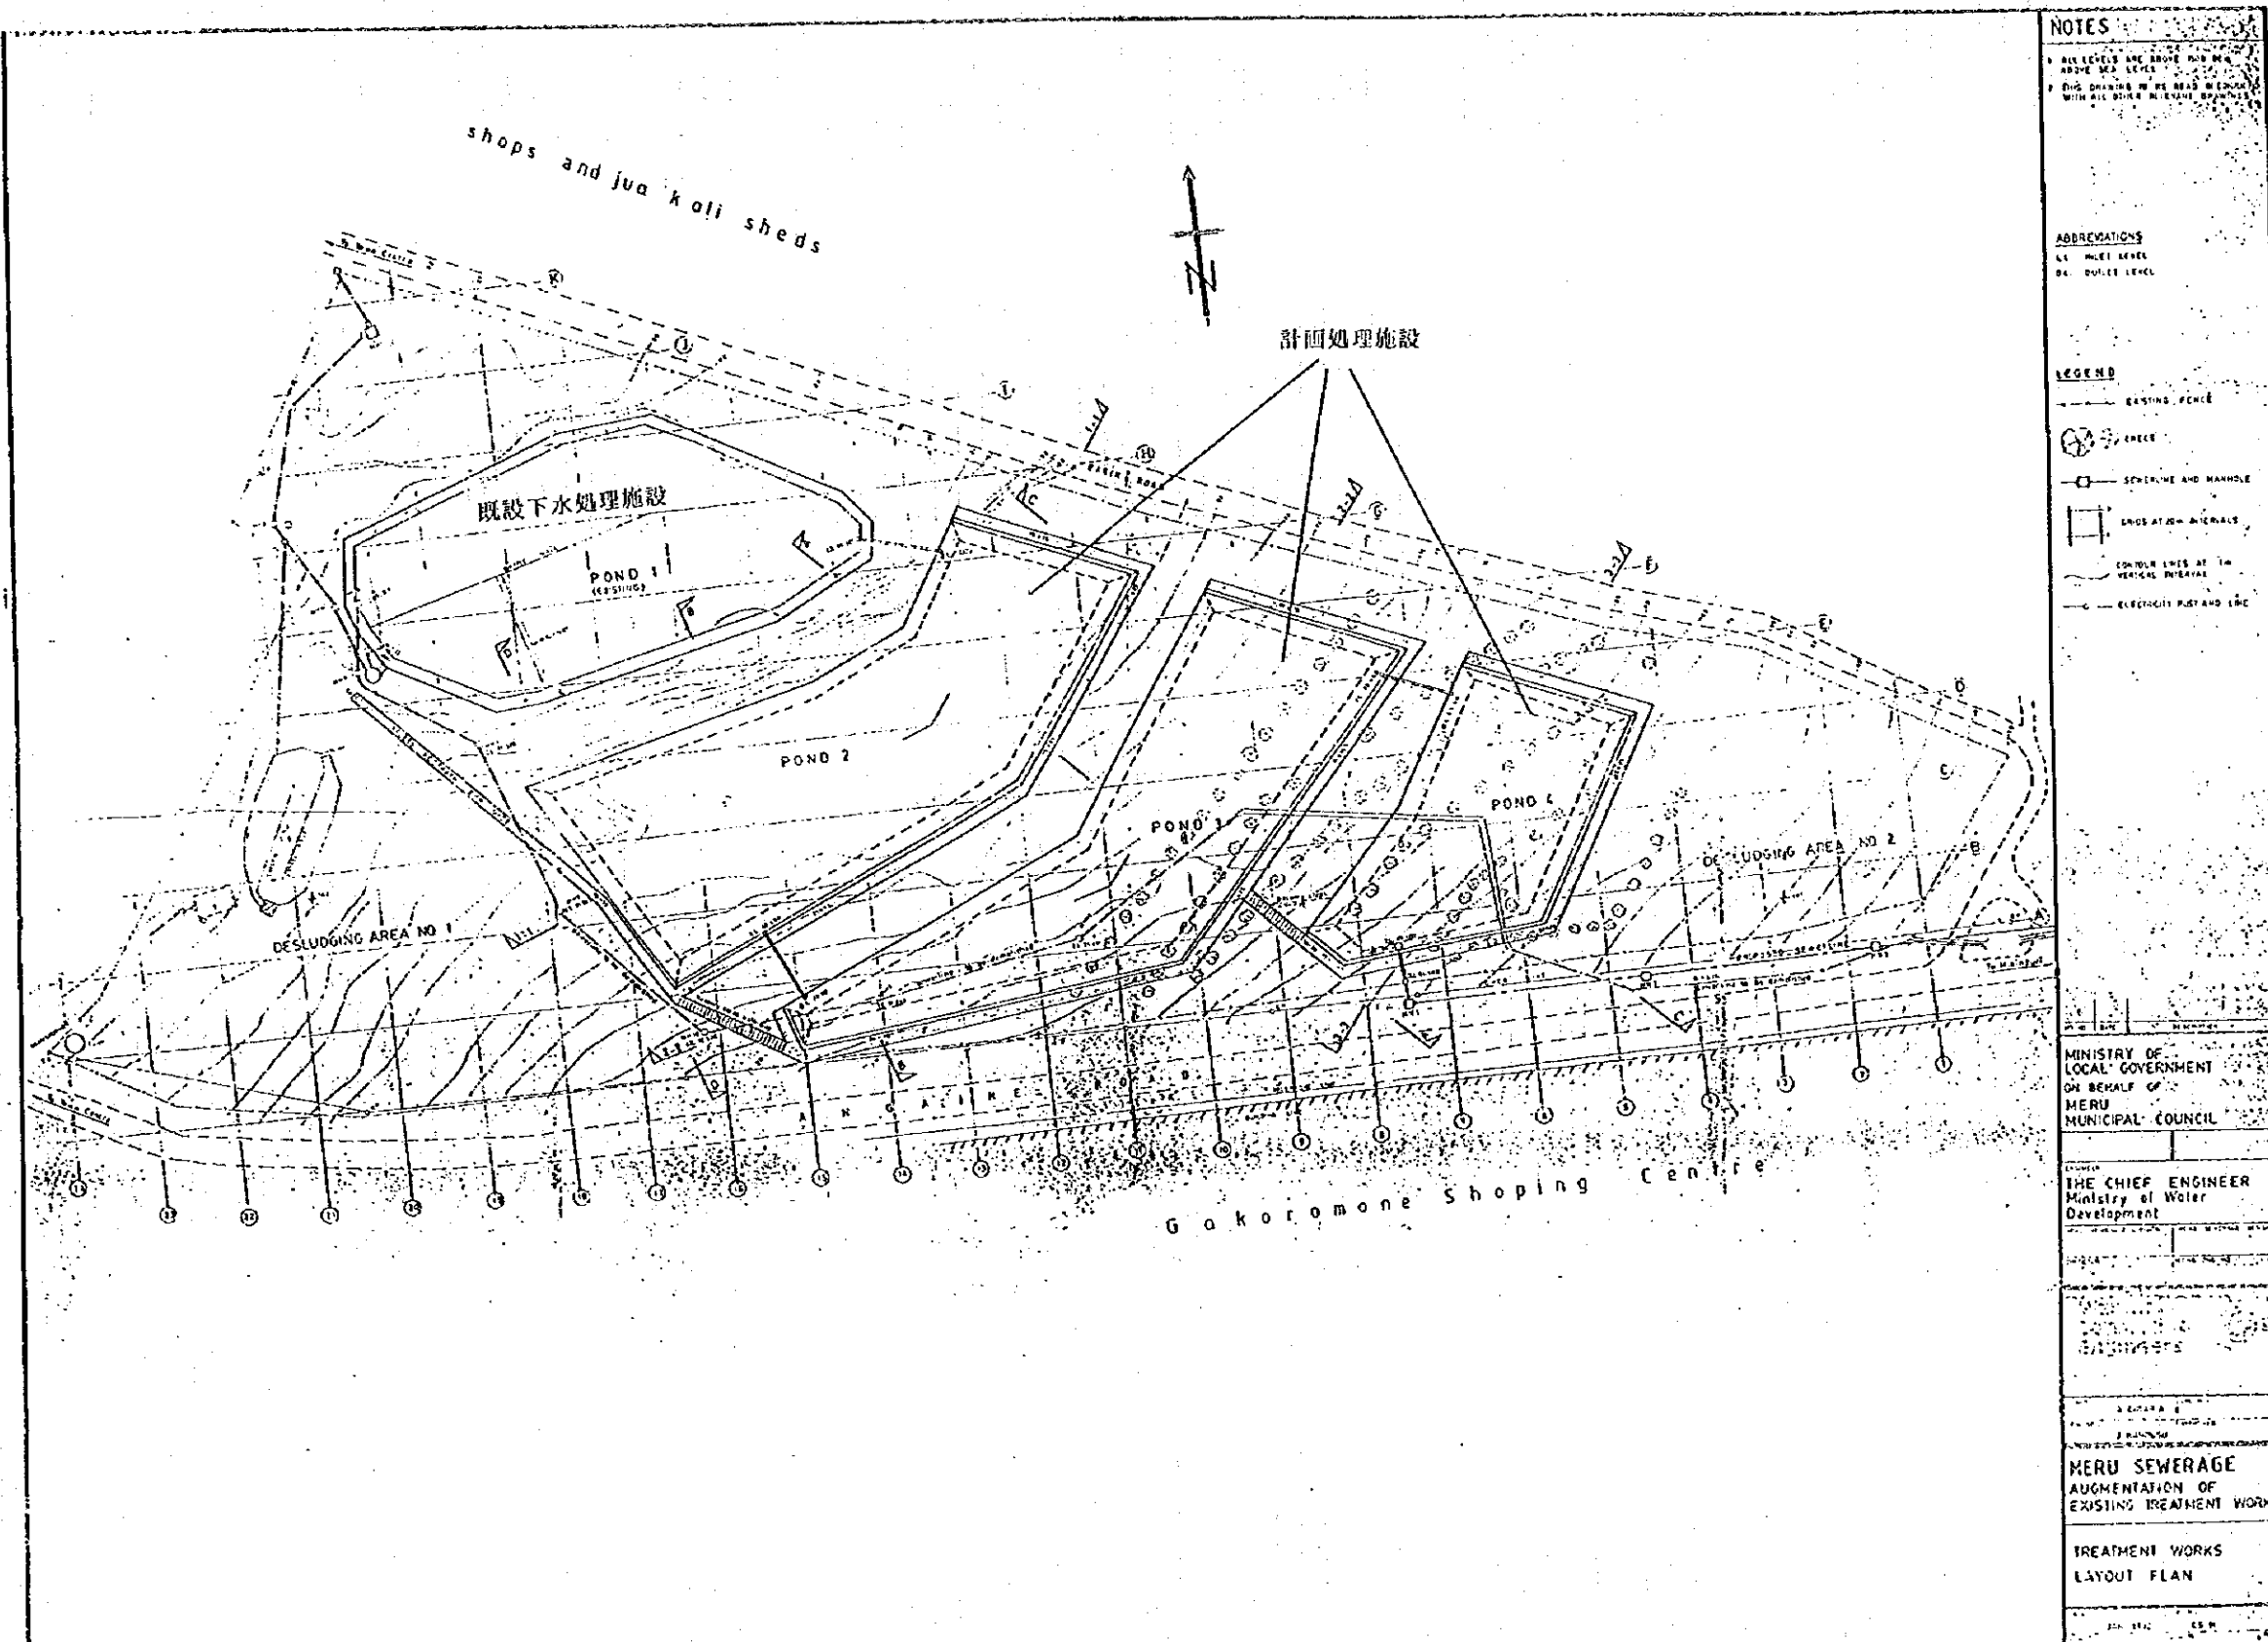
メルー市既設下水処理施設及び計画処理施設平面図
